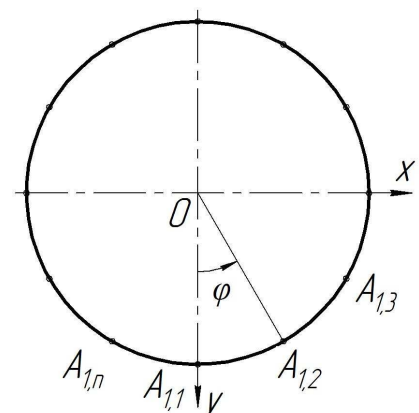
Основание цилиндрической поверхности резервуара.
